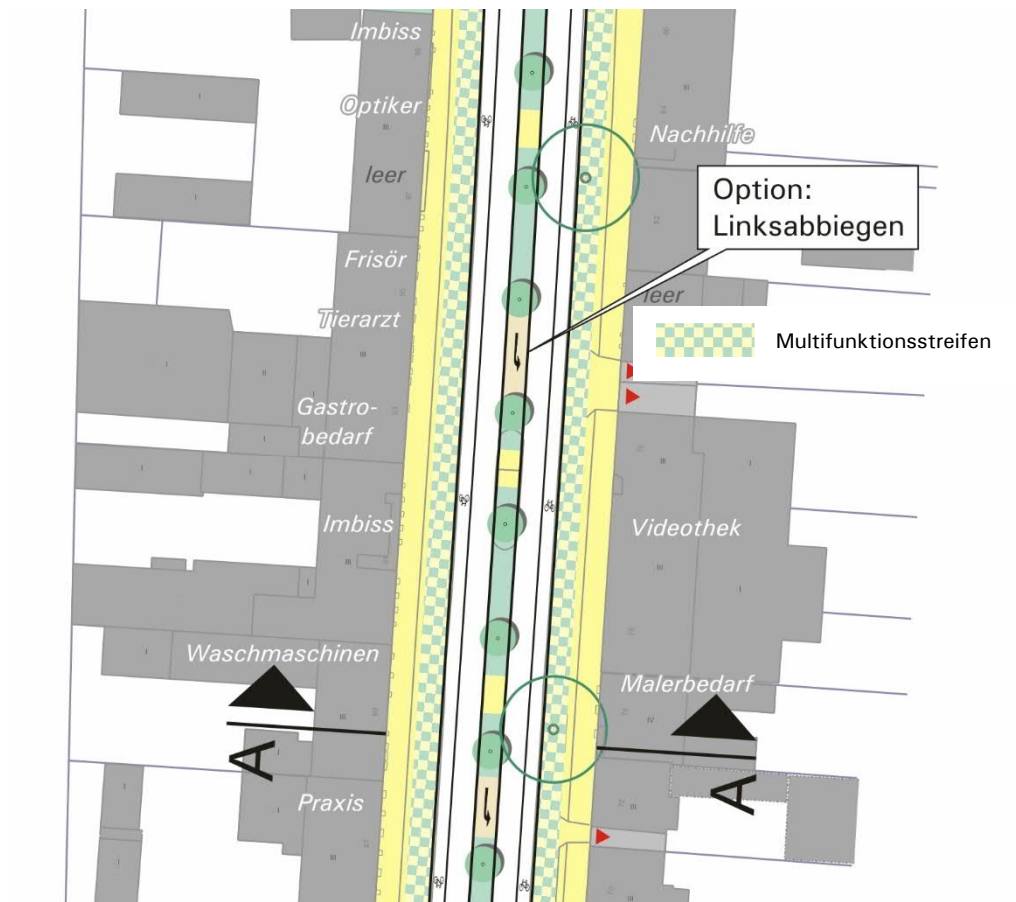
Lageplanausschnitt Urbaner Raum – Variante 3 Grüne Achse
